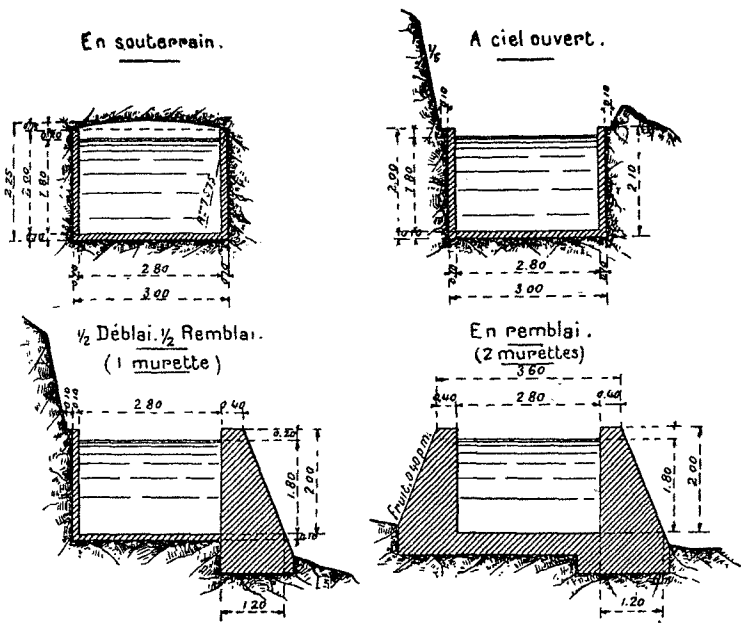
A 7. — COUPES EN TRAVERS DU CANAL D'AMÉNÉE SUIVANT QU'IL EST EN SOUTERRAIN OU A CIEL OUVERT
